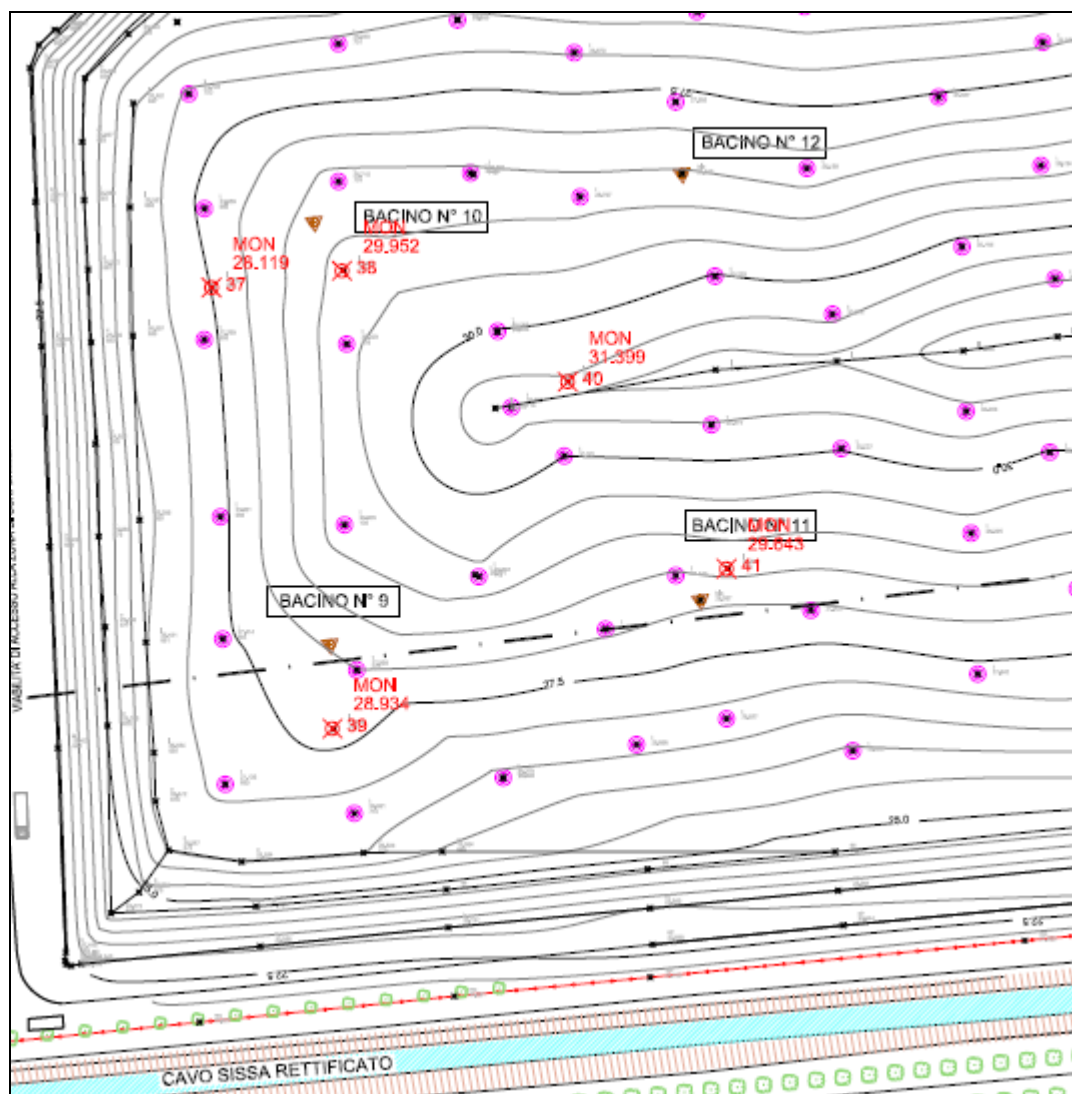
Stralcio planimetrico punti di monitoraggio bacini 9÷12.
